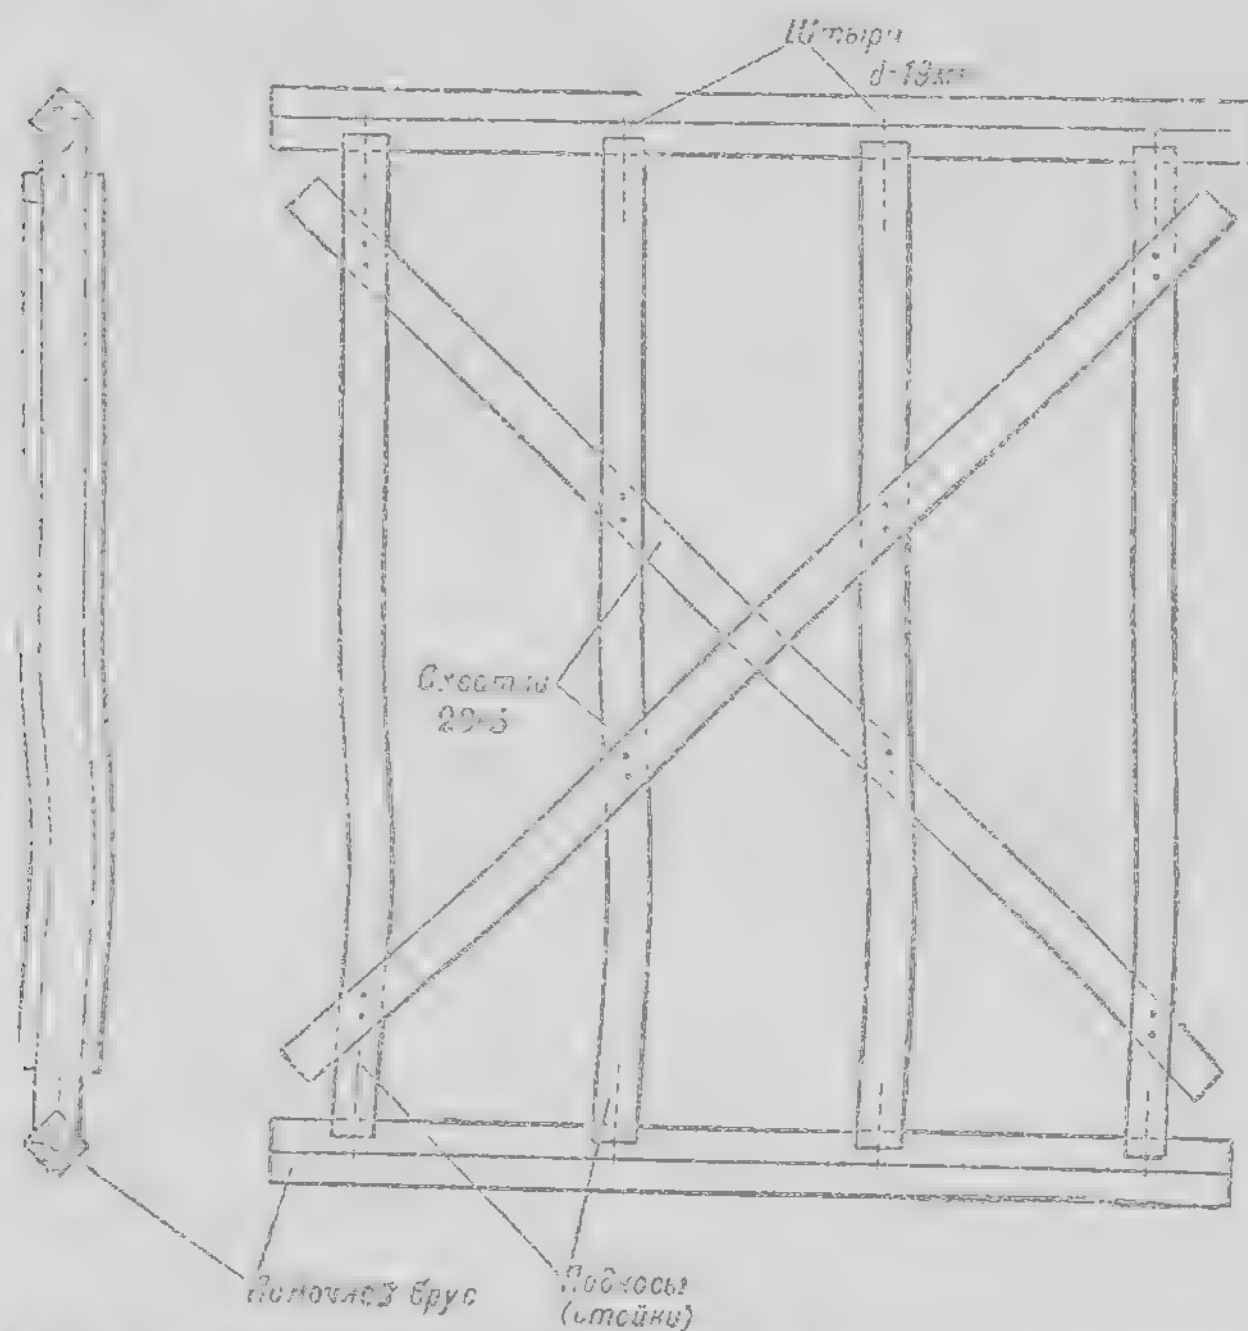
Конструкция подкосной рамы при установке под углом 45° .
